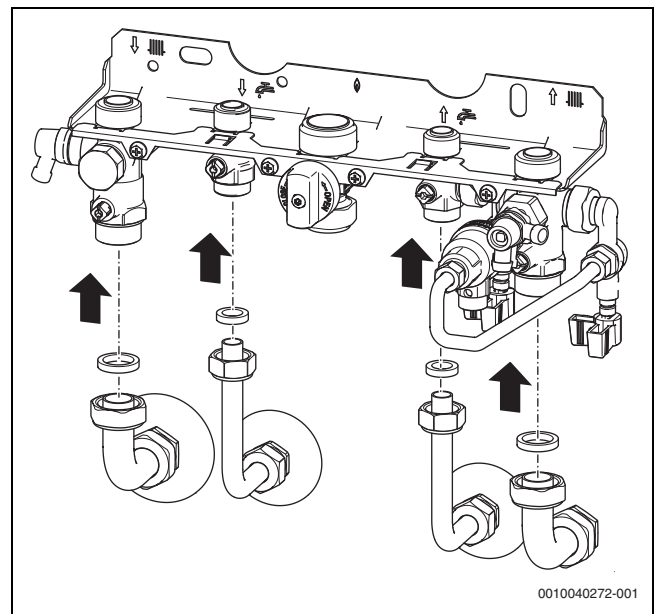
Röhre mit Dichtungen an Montageanschlussplatte montieren
